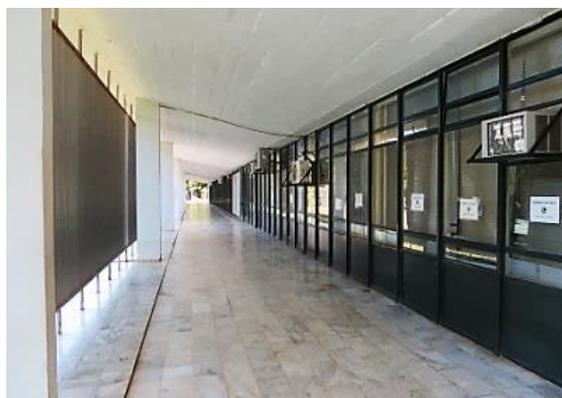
Vista G: alpendre da fachada Leste. Foto da Autora (jul/2015)
